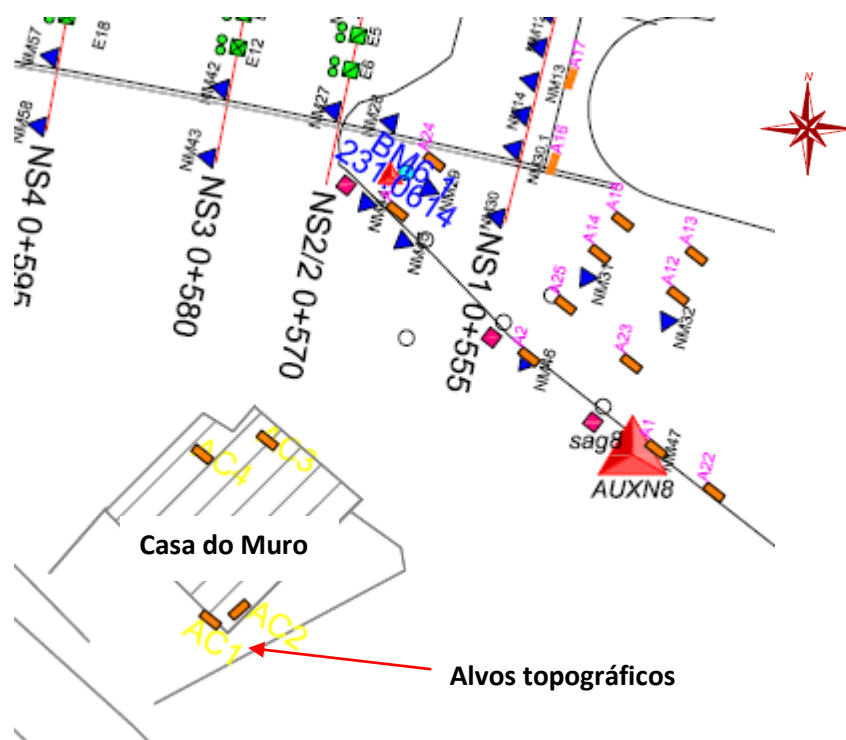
Instrumentação da Casa do Muro (emboquilhamento Nascente)
